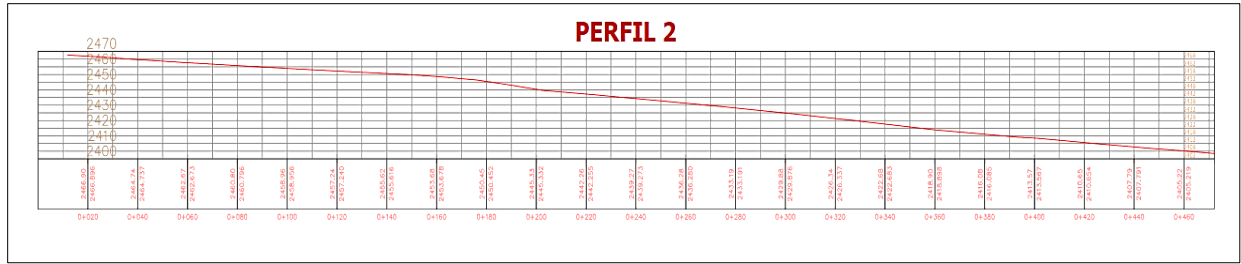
Perfil longitudinal generado en Civil 3D con estación total. Fuente: Autoría.
